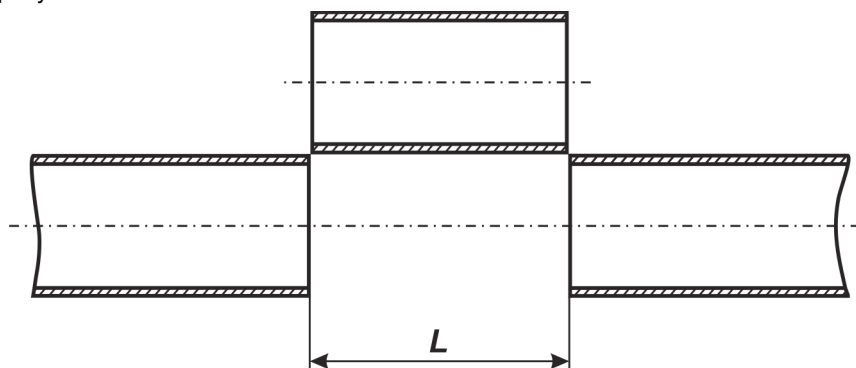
Врезка в трубопровод при установке расходомера
